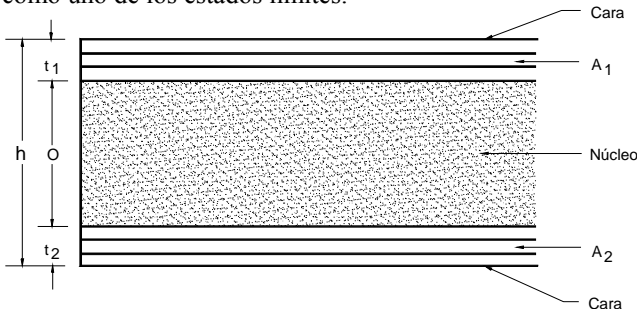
Sección transversal de un panel tipo sándwich con caras contrachapadas
